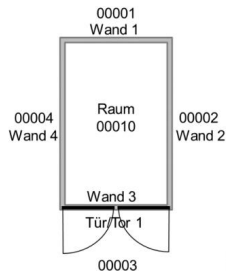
Grundriss mit exemplarischer Lokalisierungsbezeichnung der Beispielgarage 2
